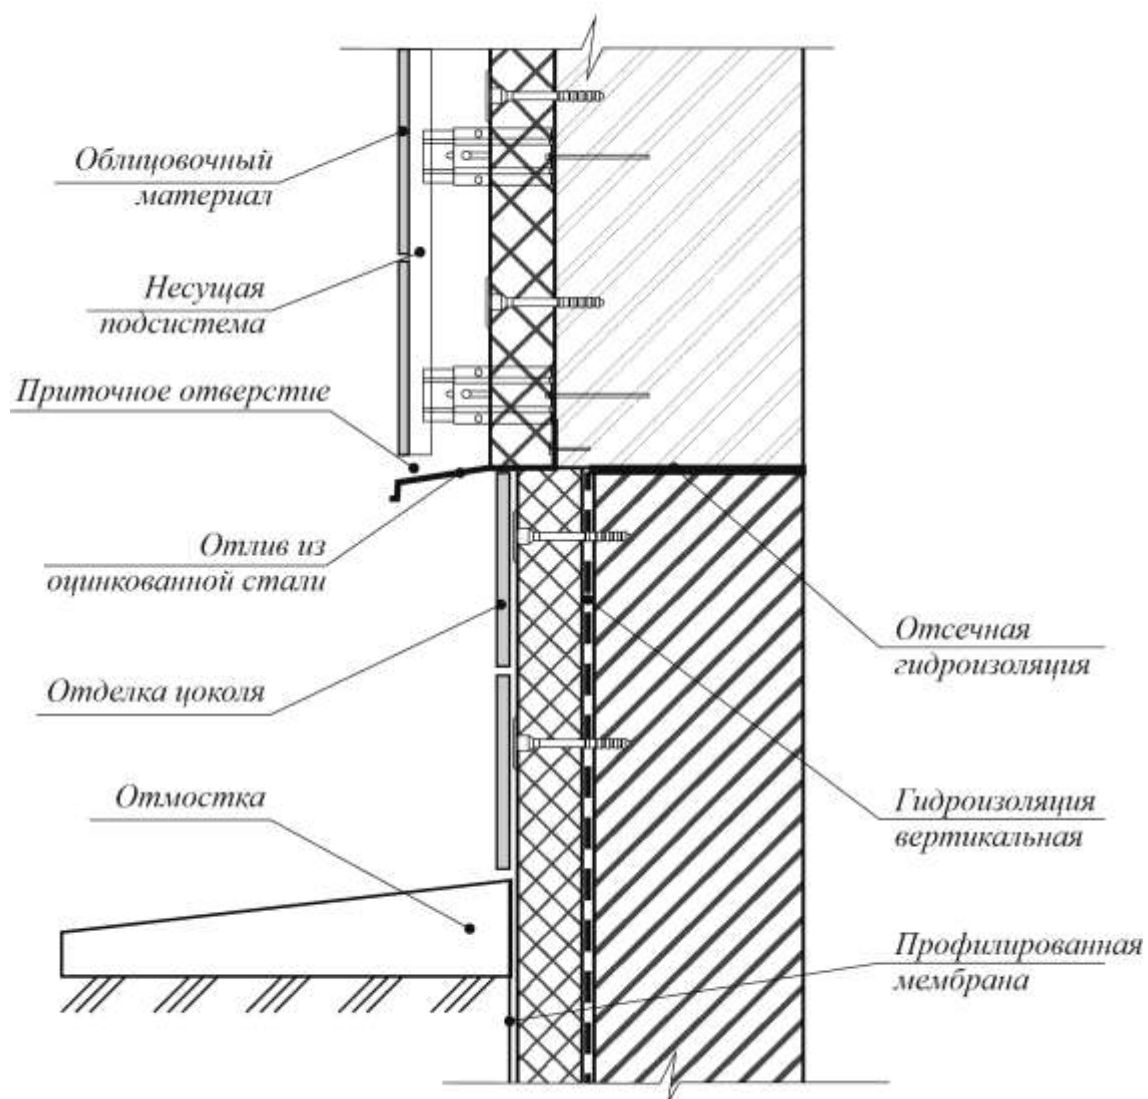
Узел примыкания навесного фасада к цоколю
